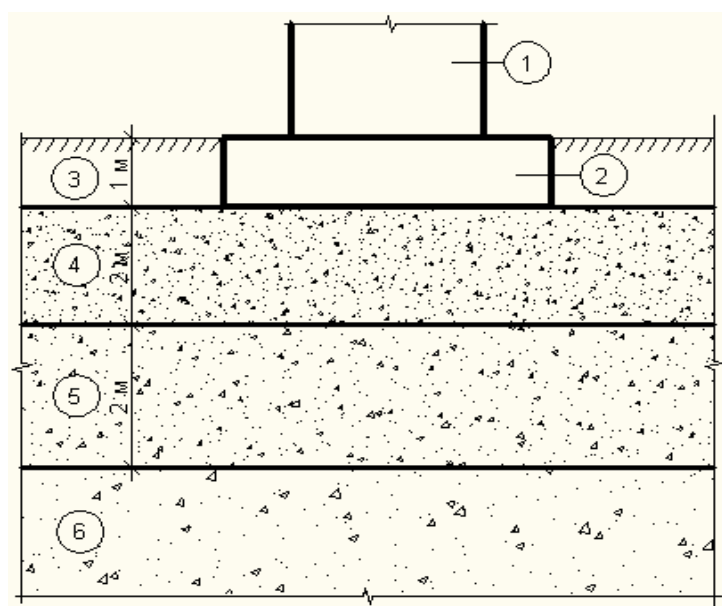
Фундамент и основания промежуточной опоры подземного перехода: 1-опора; 2-фундамент; 3-обратная засыпка; 4-гравийно-песчаная смесь оптимальной фракции (ГПС); 5-строительный мусор; 6-галечниковый грунт.
